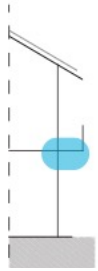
(destra) Elemento di separazione in Vetro cellulare, posto alla base del pannello e di separazione con la fondazione in calcestruzzo armato.
